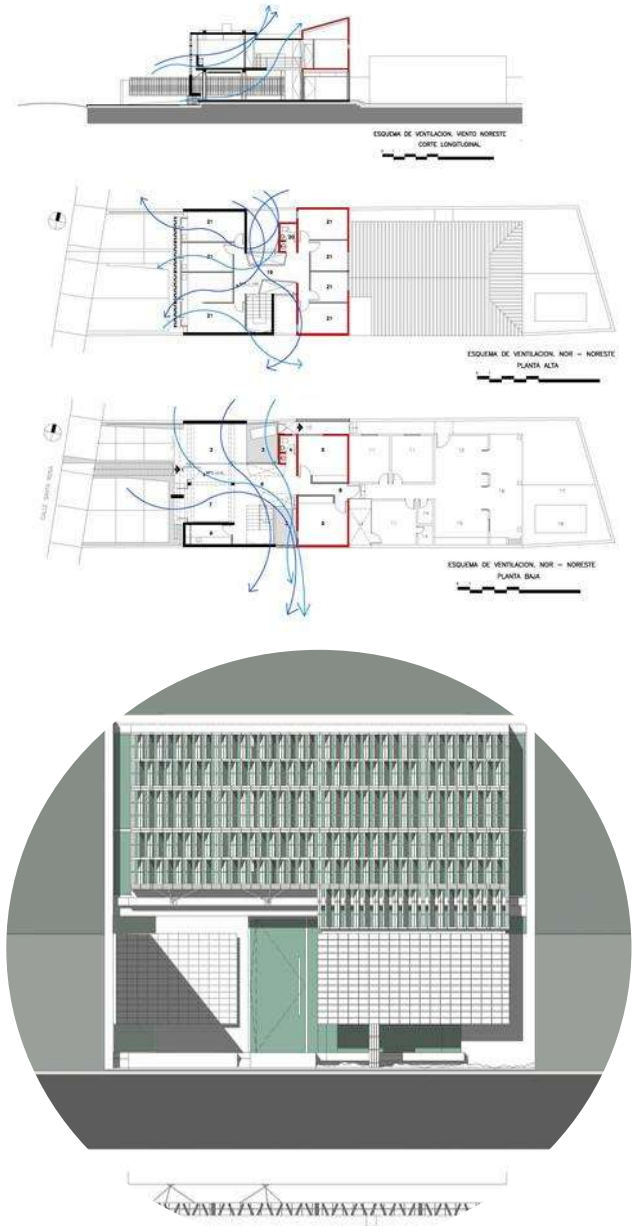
Plantas y diseño de fachada de la Clínica Paraguay- Autor: Estudio ELGUE-Fuente: ArchDaily.
